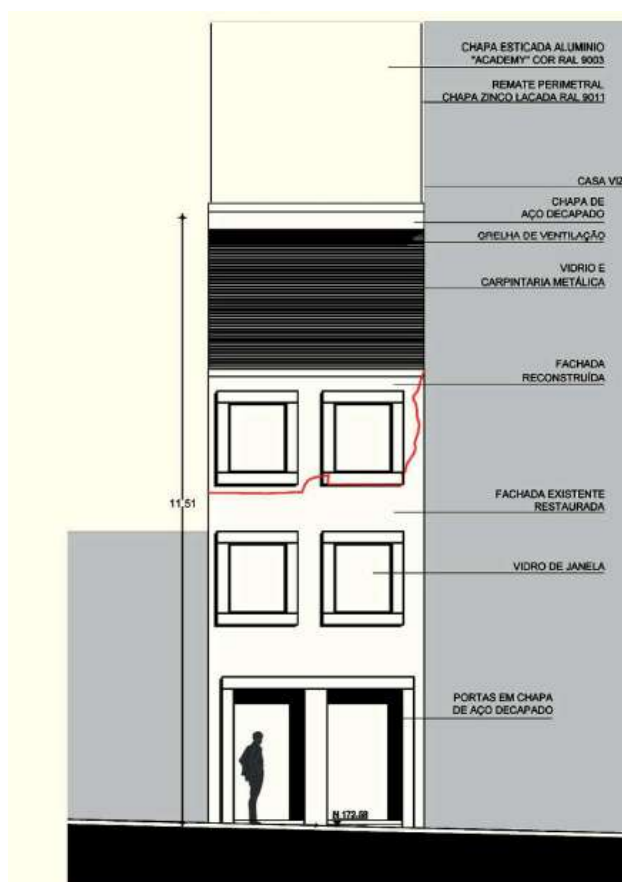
Reconstrução da Fachada da Rua Cruz de Pedra
